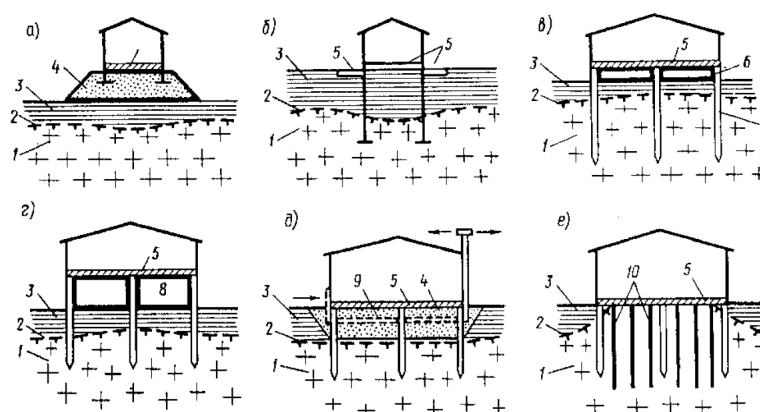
Сохранения мерзлого состояния грунтов: 1 – вечномёрзлый грунт; 2- верхняя граница слоя вечномёрзлого грунта; 3- деятельный слой; 4 – насыпной пучинистый грунт; 5 – теплоизоляция; 6 – вентилируемое подполье; 7 – сваи; 8 – неотапливаемый 1-й этаж; 9 – вентиляционные каналы; 10 – замораживающие колонки
